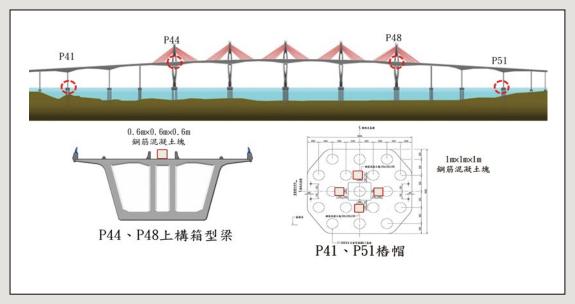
長期鋼筋混凝土材料腐蝕試驗配置示意圖
